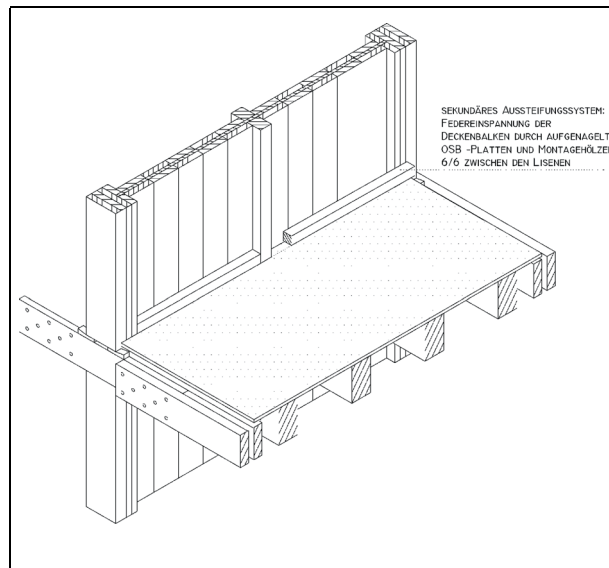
Rohbau Knoten Wand – Decke mit Skelettstütze
